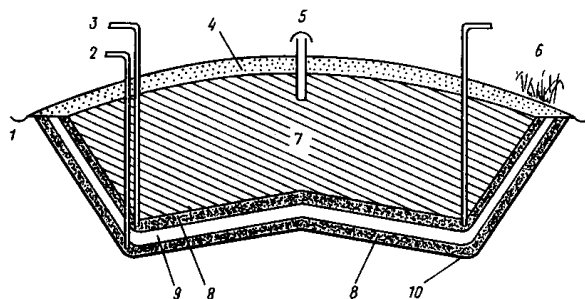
Схема безопасной свалки с двойной системой покрытия нижнего основания [6]: 1 – сливная канава; 2 – система контроля за утечками; 3 – удаление жидкости; 4 – грунтовое покрытие; 5 – газовая вентиляция; 6 – растительность; 7 – опасные отходы; 8 – проницаемый слой; 9 – непроницаемый слой; 10 – мембрана покрытия
